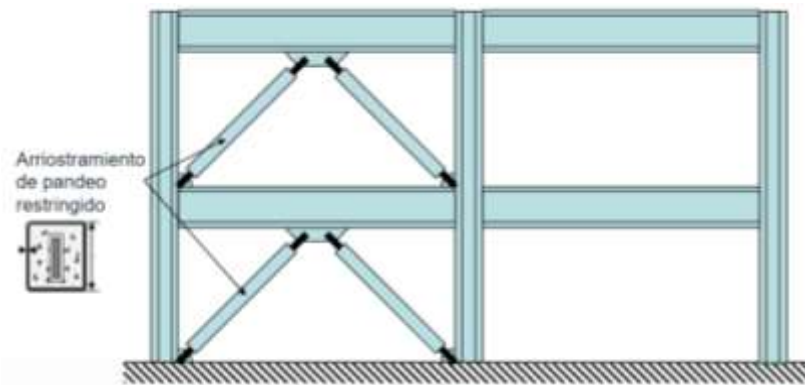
Marco de acero con diagonales de pandeo restringido BRB. Fuente: Presentación del Departamento de Ingeniería Civil de la Universidad de Chile "Construcción Mixta"
